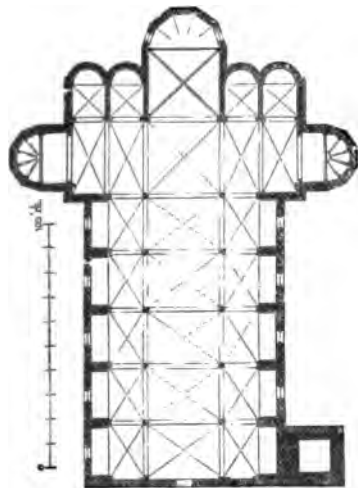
Servi zu Siena. Grundriss. (L.)
